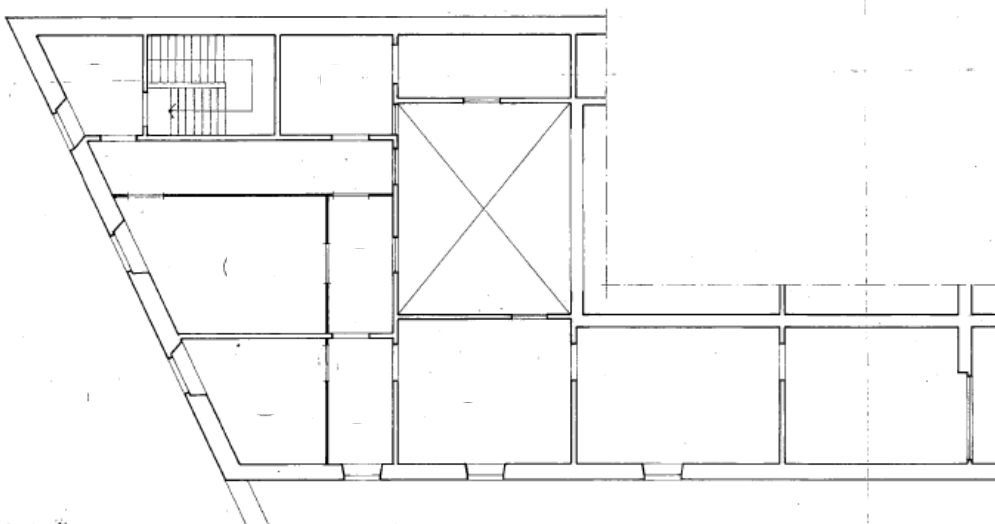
Planimetria dell'appartamento posto al piano terzo
